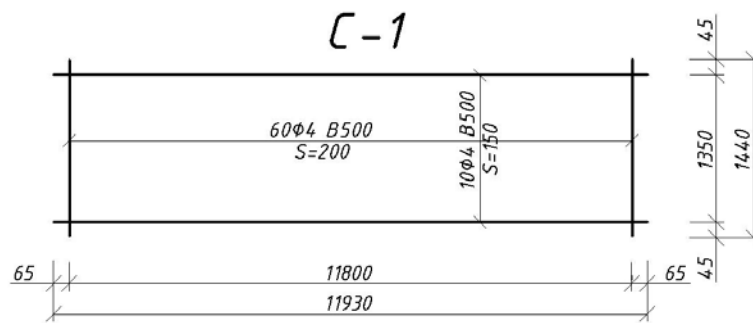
Армирование плиты поперечным каркасом.
